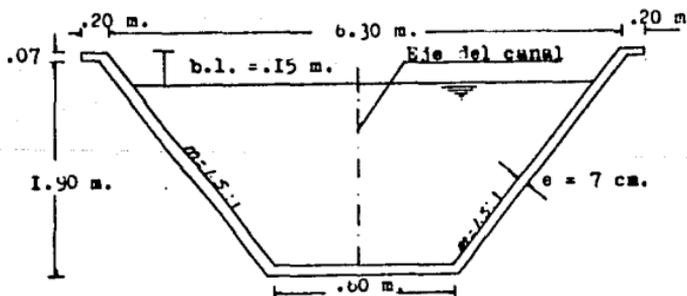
Fig. III-b' Sección transversal tipo del canal (sin esc.)
